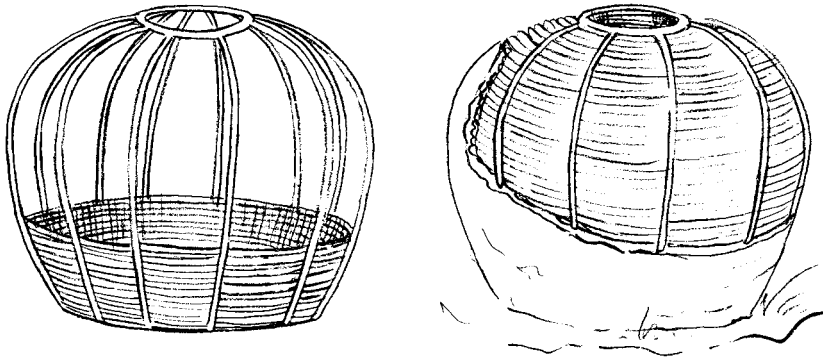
Construção de um pote de água com uma estrutura de barras de ferro ou de canas de bambu
